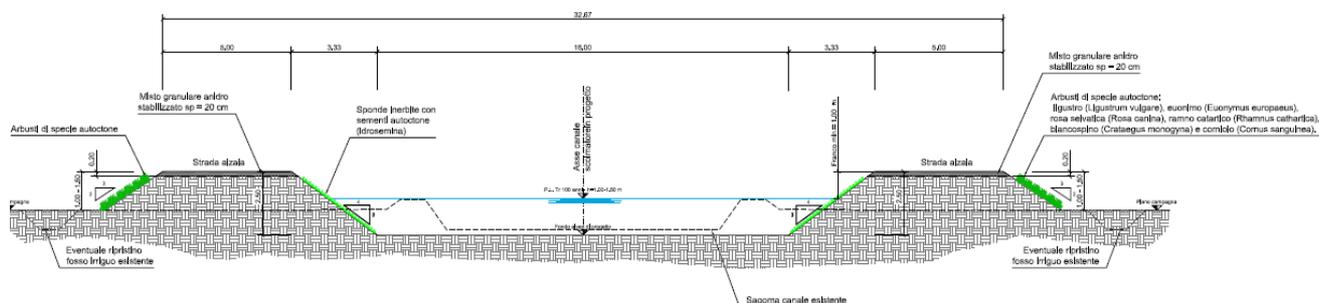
Esempio di sezione tipo del canale scolmatore in progetto
